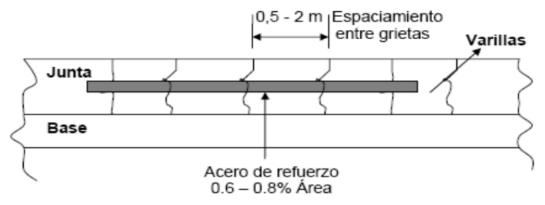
Pavimento de concreto con refuerzo continuo sin función estructural (CRCP)
